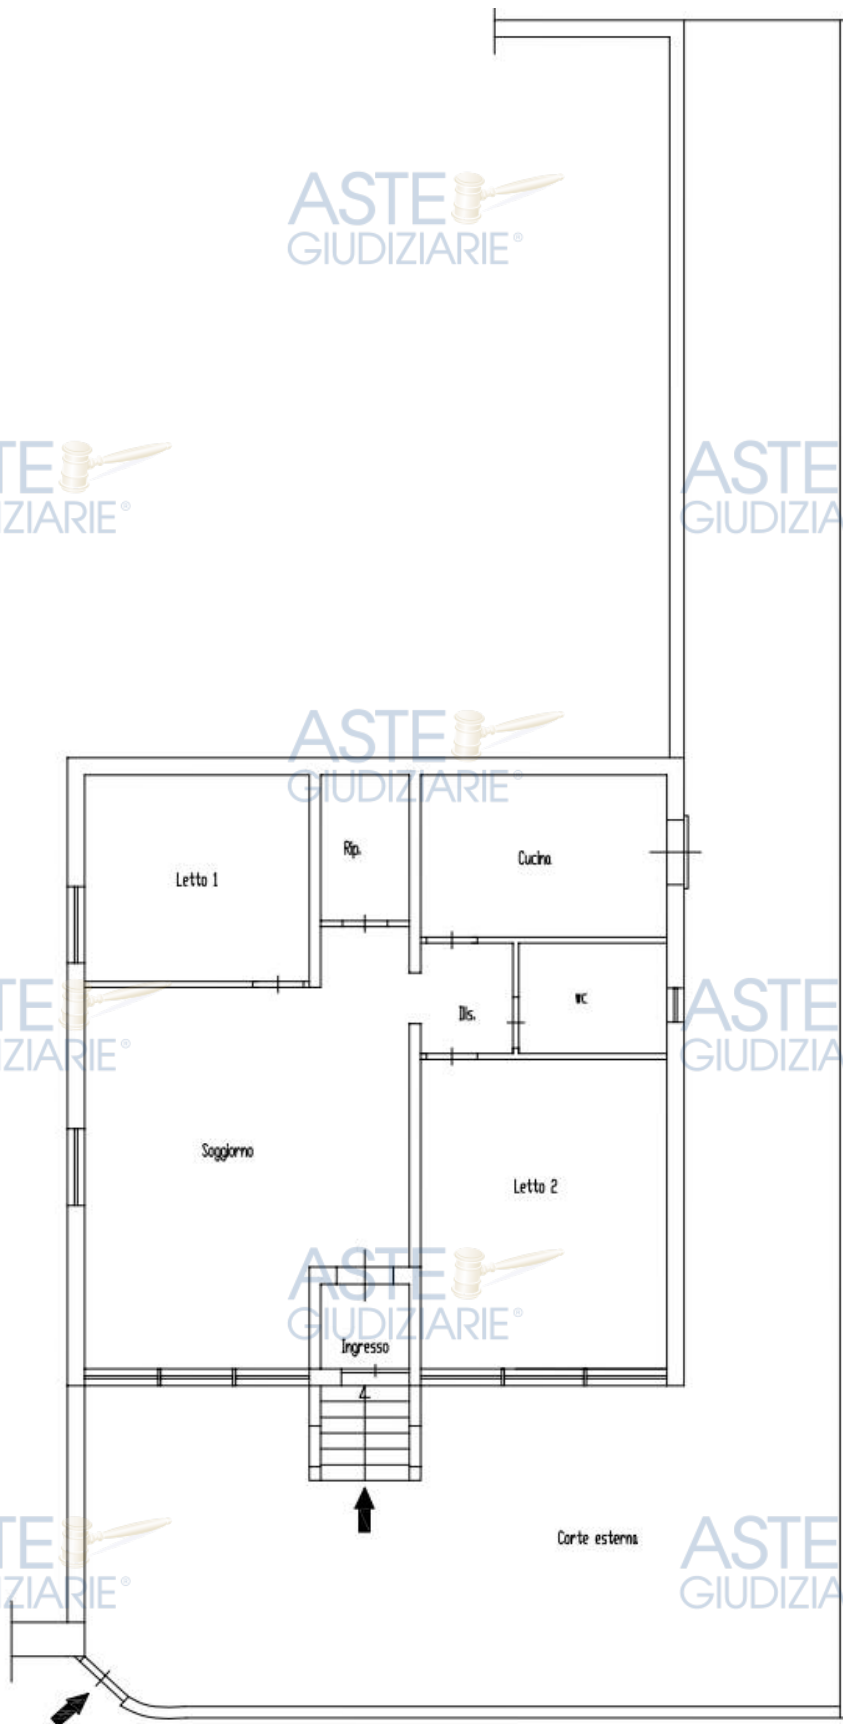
Planimetria dell'appartamento con annessa corte oggetto di pignoramento- interno 1
